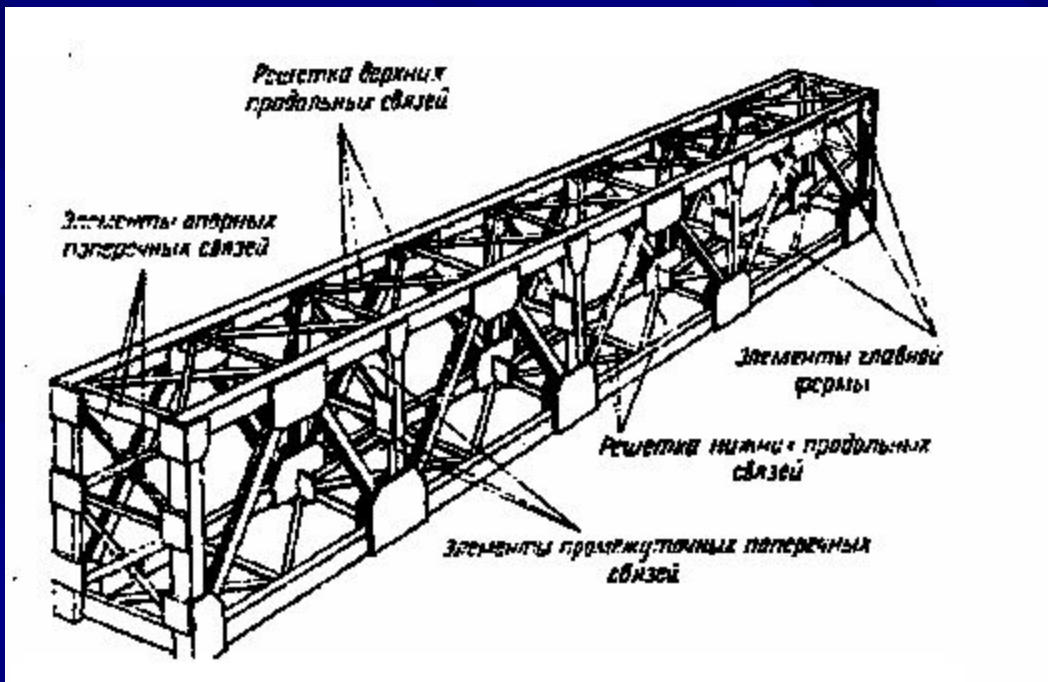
Металлическое пролетное строение со сквозными главными фермами
